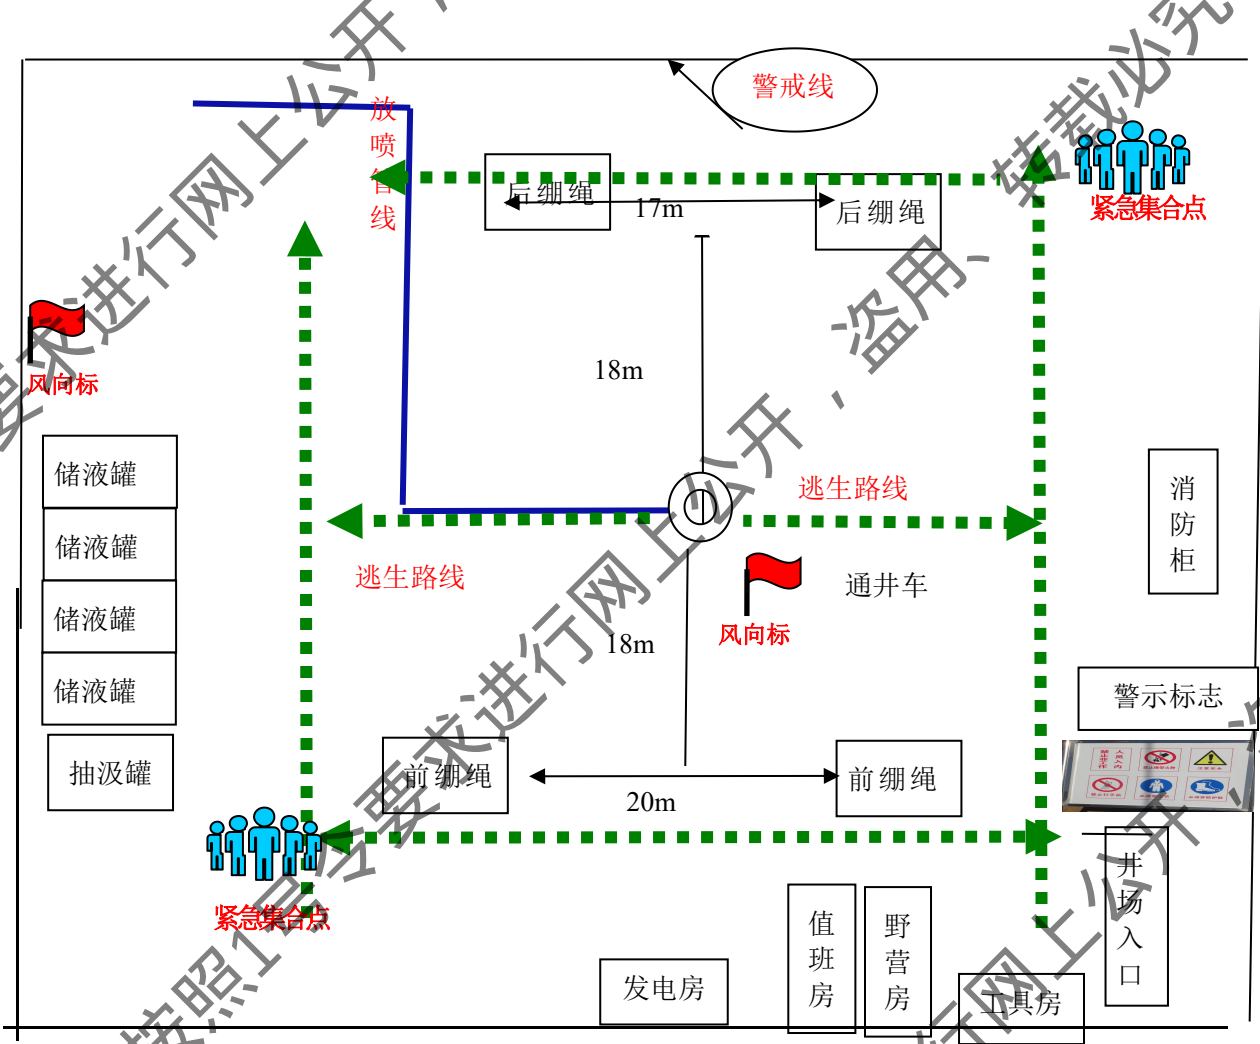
井下作业（试油）井场（峰 224 井）总平面布置图
